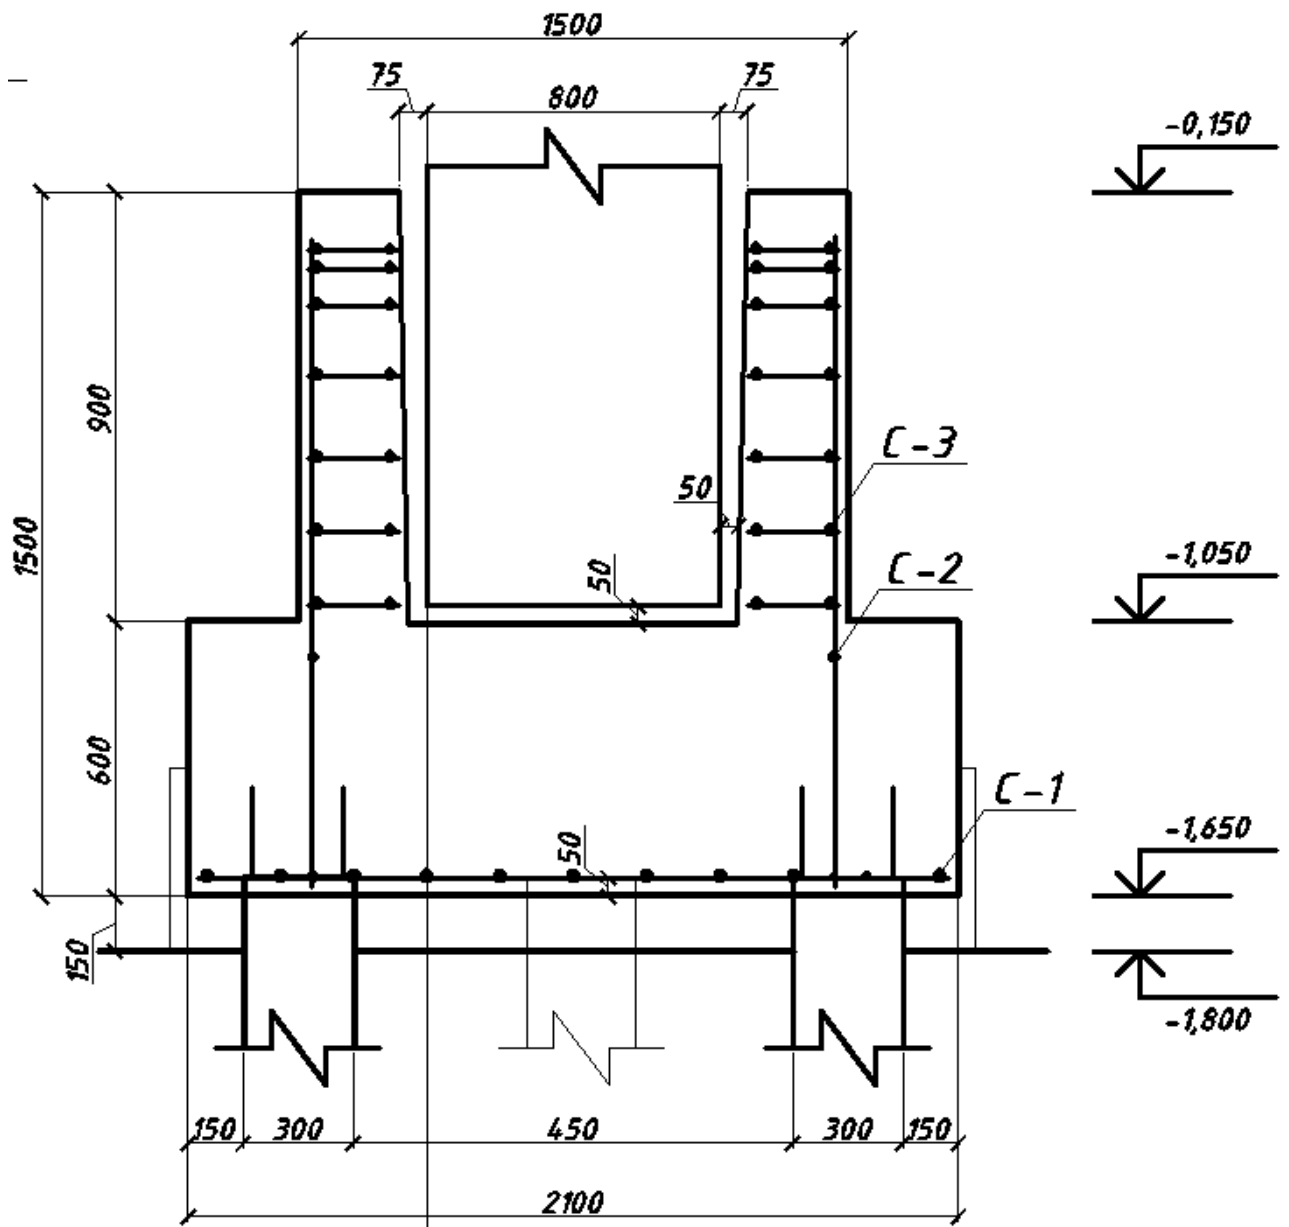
Схема армирования ростверка и стакана фундамента
